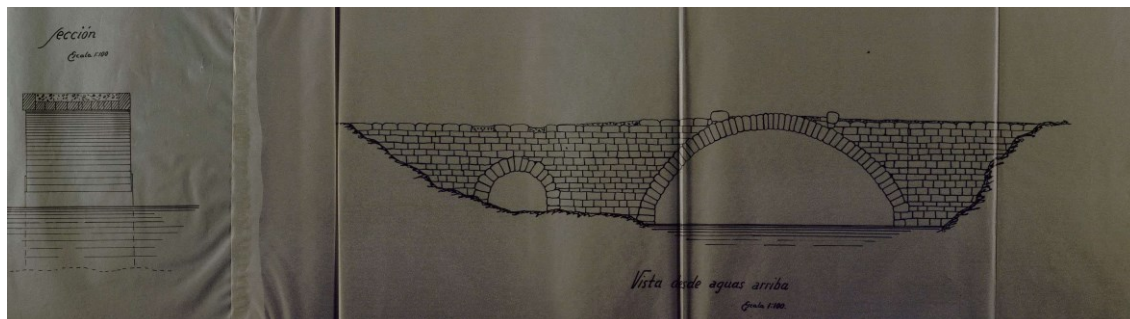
Alzado de Puento Pedriña. Fuente: Informe, 1944.
